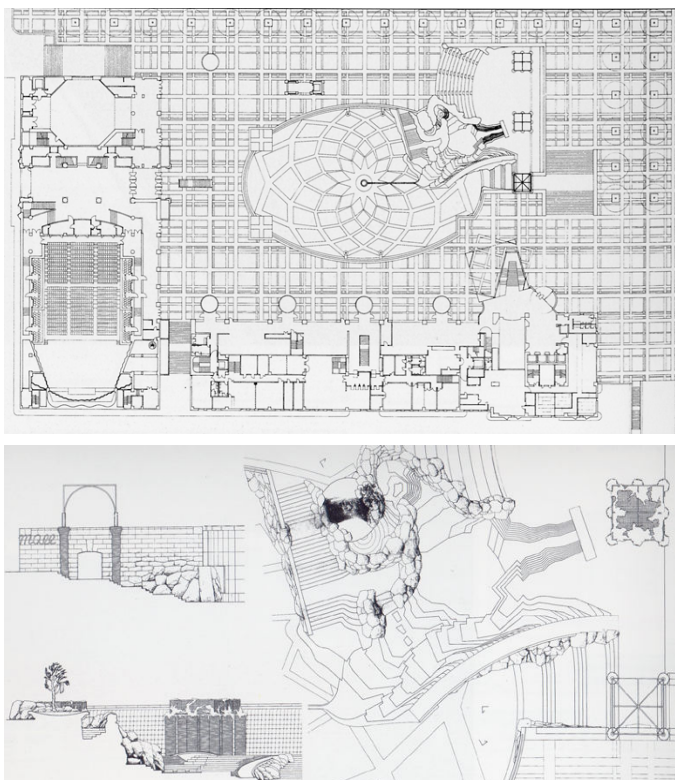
e 340. Pianta del I° piano + Sezioni e pianta del paesaggio artificiale della piazza.
